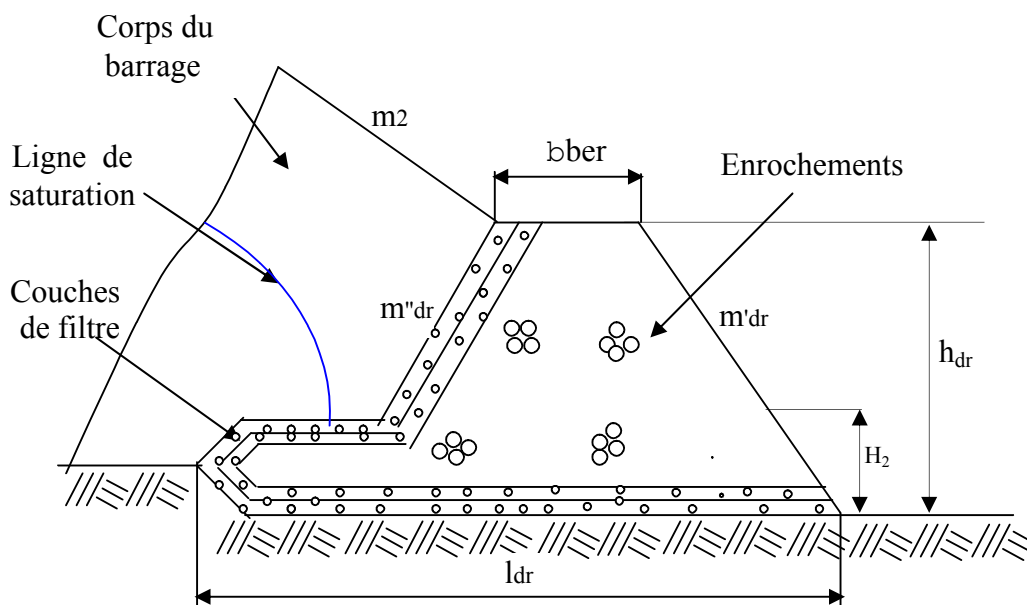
Prisme de drainage avec drain tapis interne sur fondations perméables
